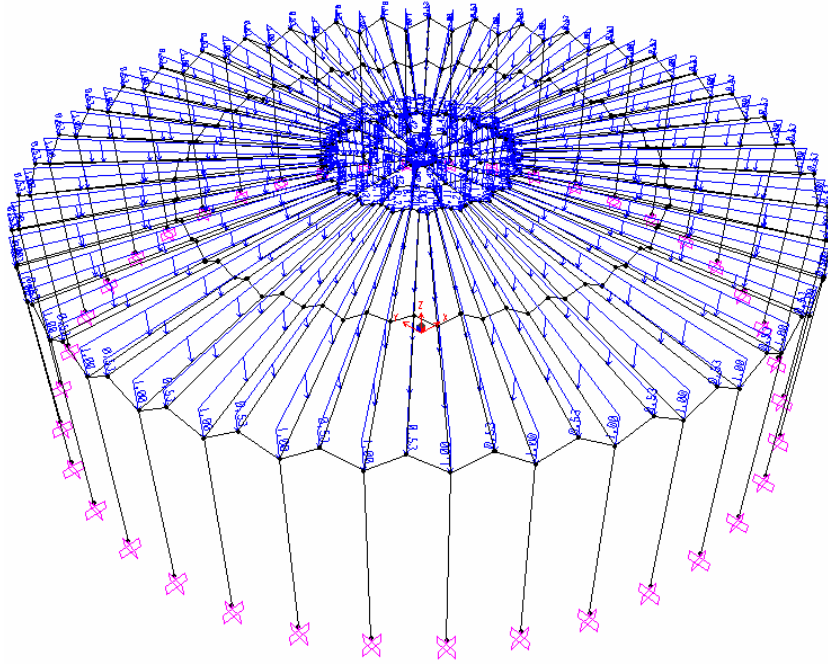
Yapı Statik Modeli Kesit Görünüşü
